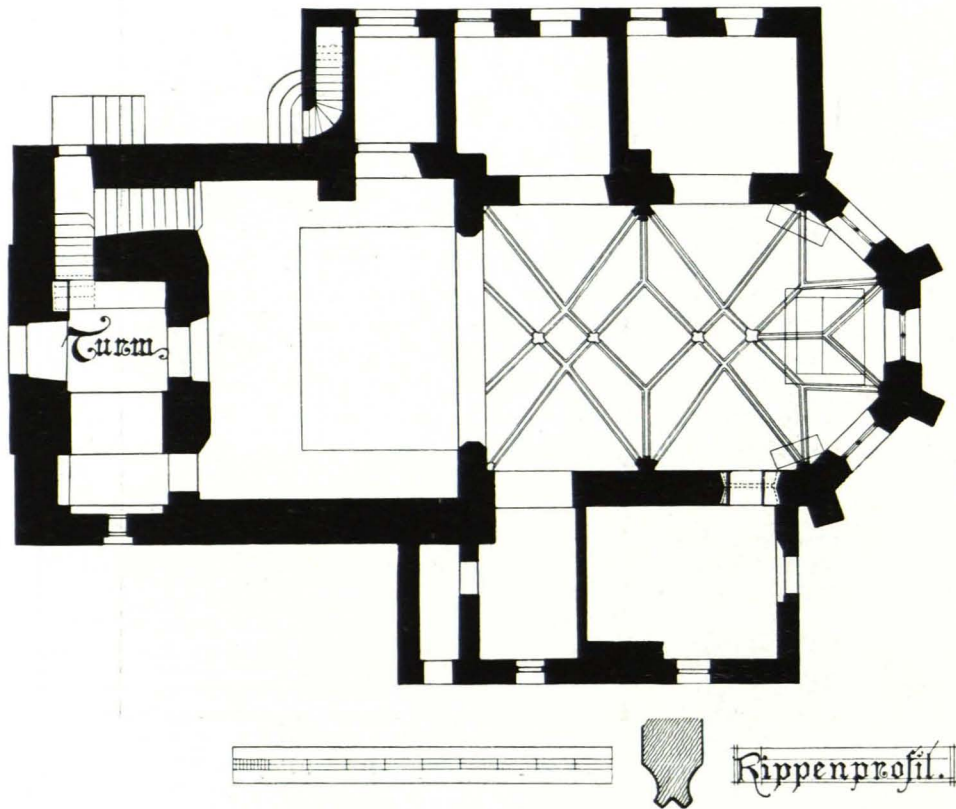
Persenbeug, Pfarrkirche, Grundriß 1:200 (S. 140)
